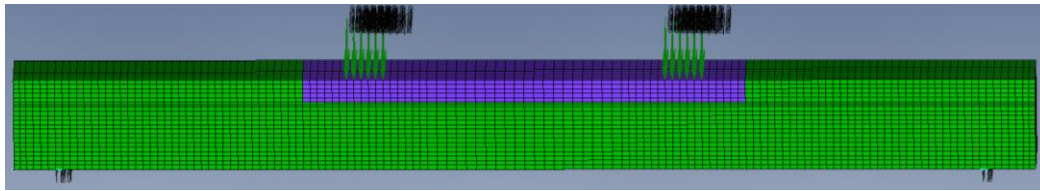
Залізобетонна балка із відновленою стиснутою зоною
